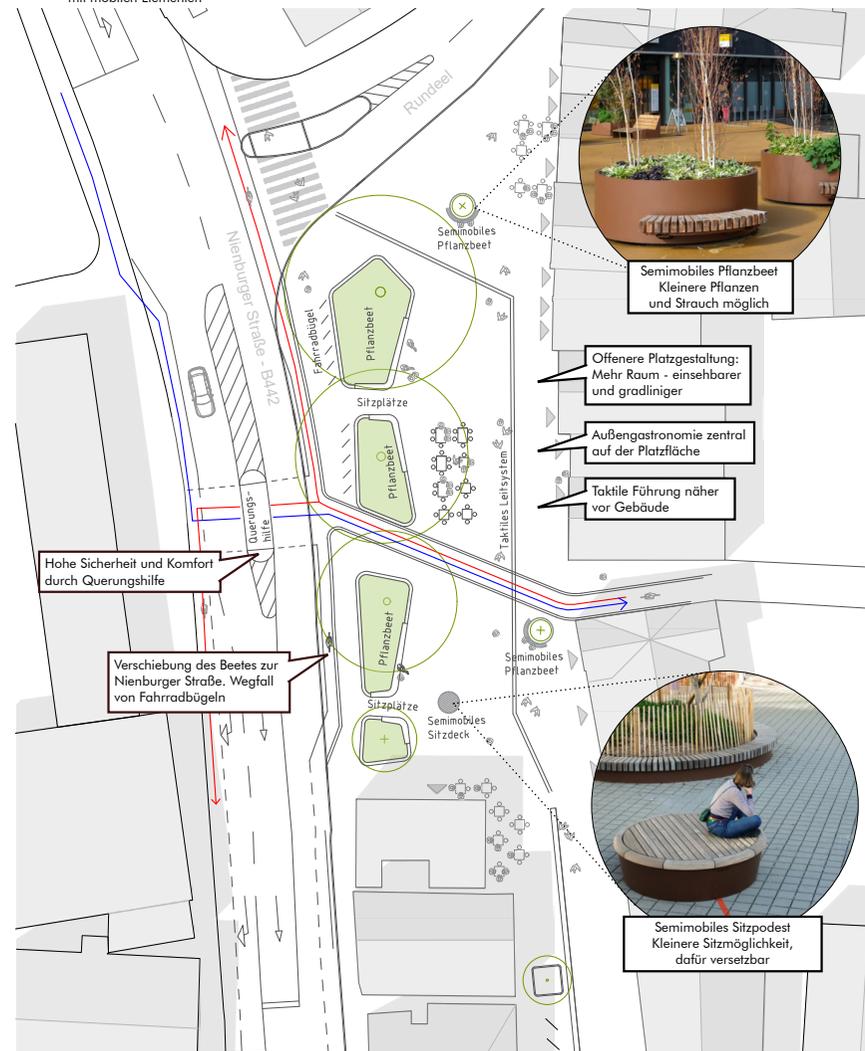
beschlossene Planungsvariante (Darstellung und Fotos: kerck & partner)
